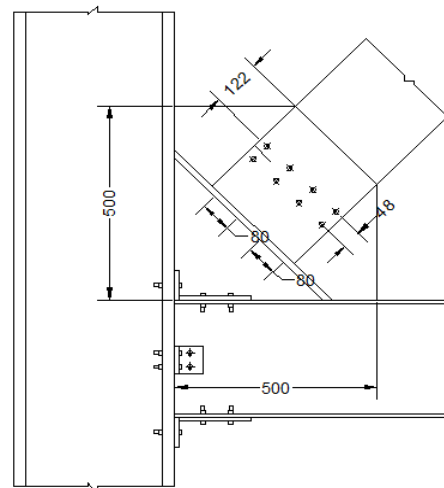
Sambungan Balok Induk dengan Kolom
